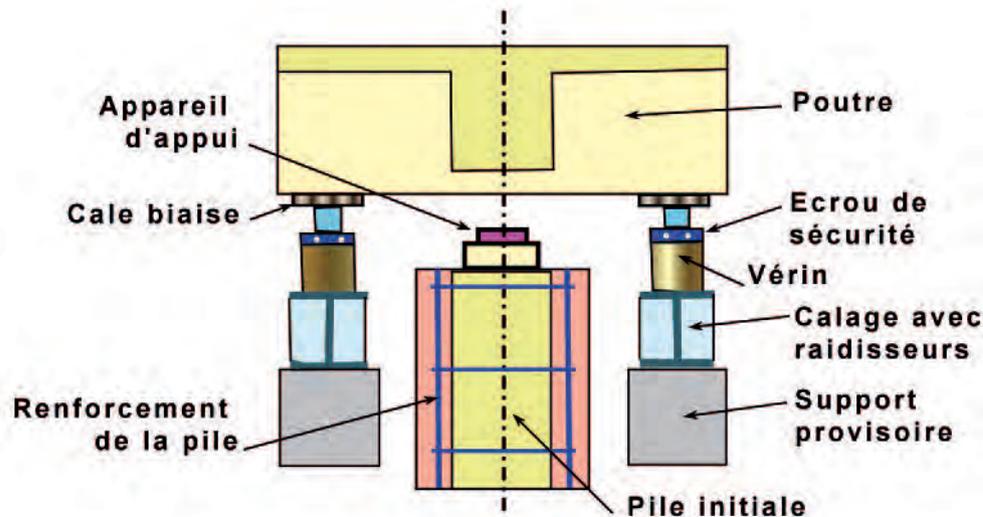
schéma d'un dispositif de mise en charge d'un poteau après renforcement
